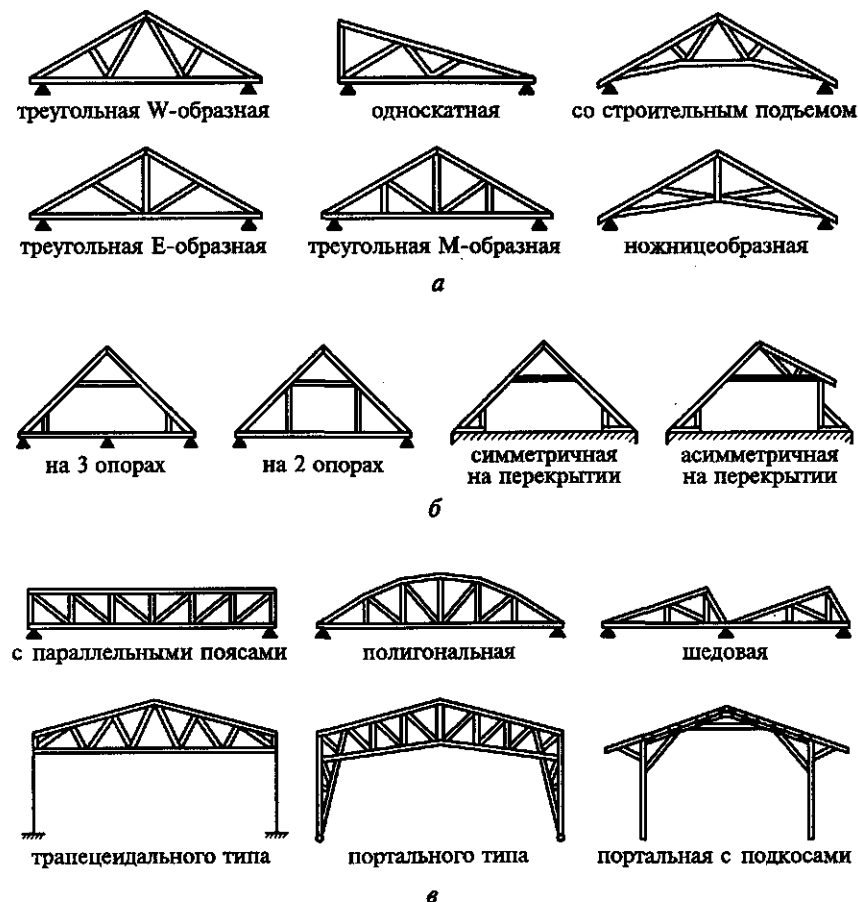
Фермы, применяемые в деревянном строительстве:
